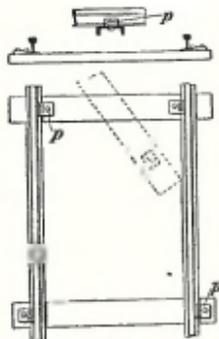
Befestigung von Schienen auf eisernen Schwellen.
